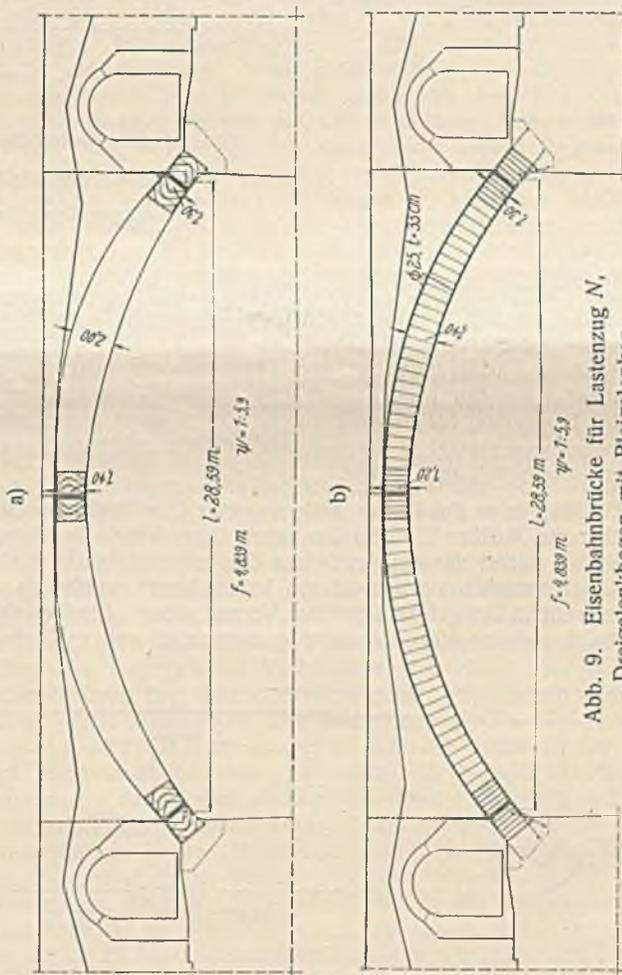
Eisenbahnbrücke für Lastenzug N, Dreiecksbogen mit Bleigelenken.
